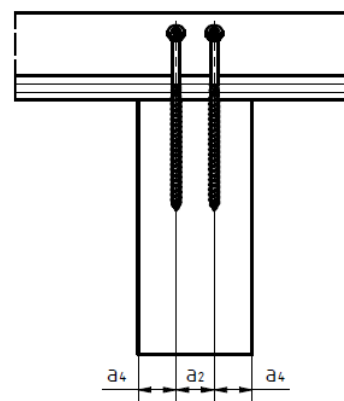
Grundsätzlicher Aufbau des Holz-Beton-Verbund-Systems
